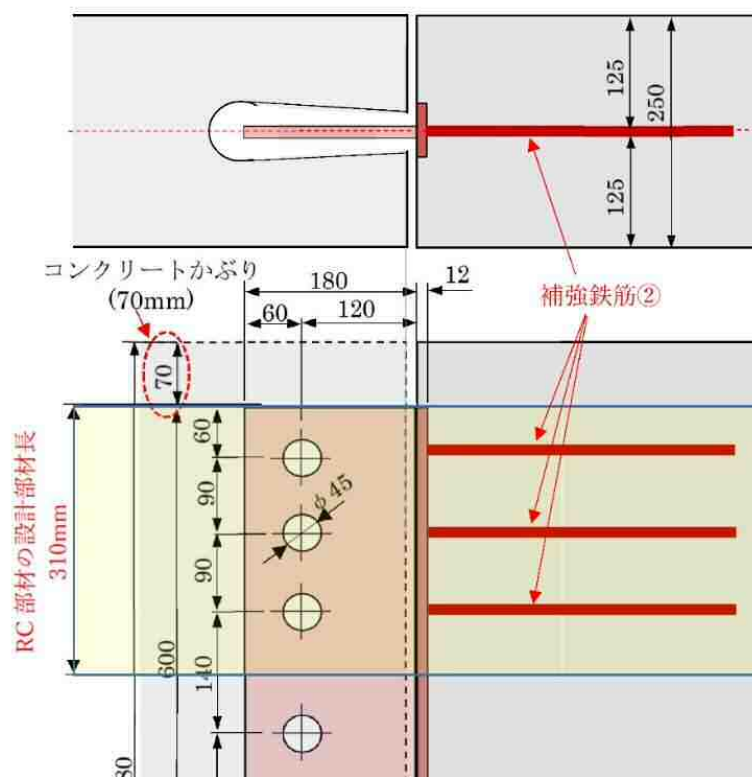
補強鉄筋②の設計範囲と補強鉄筋の配置
